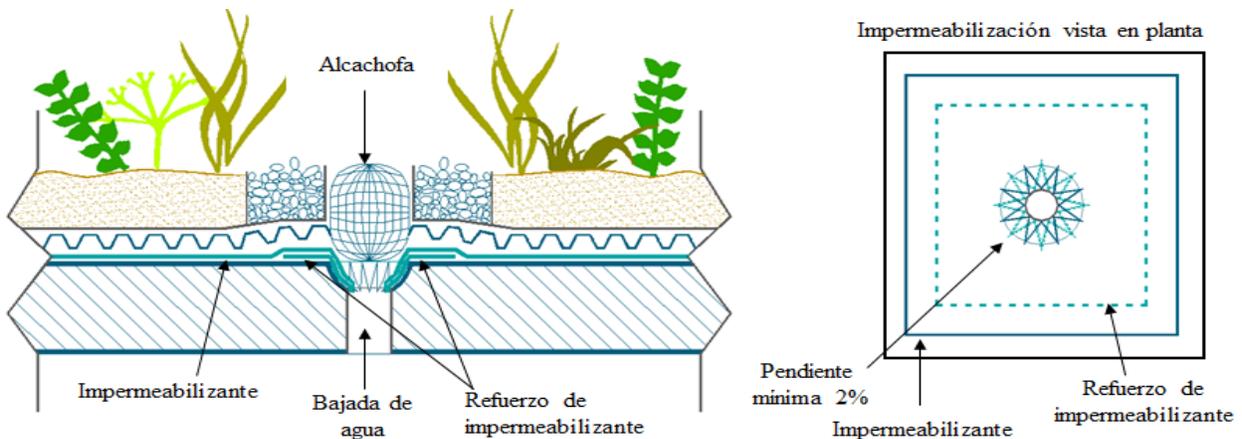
Impermeabilización y refuerzo en puntos de encuentro con bajadas de agua.
